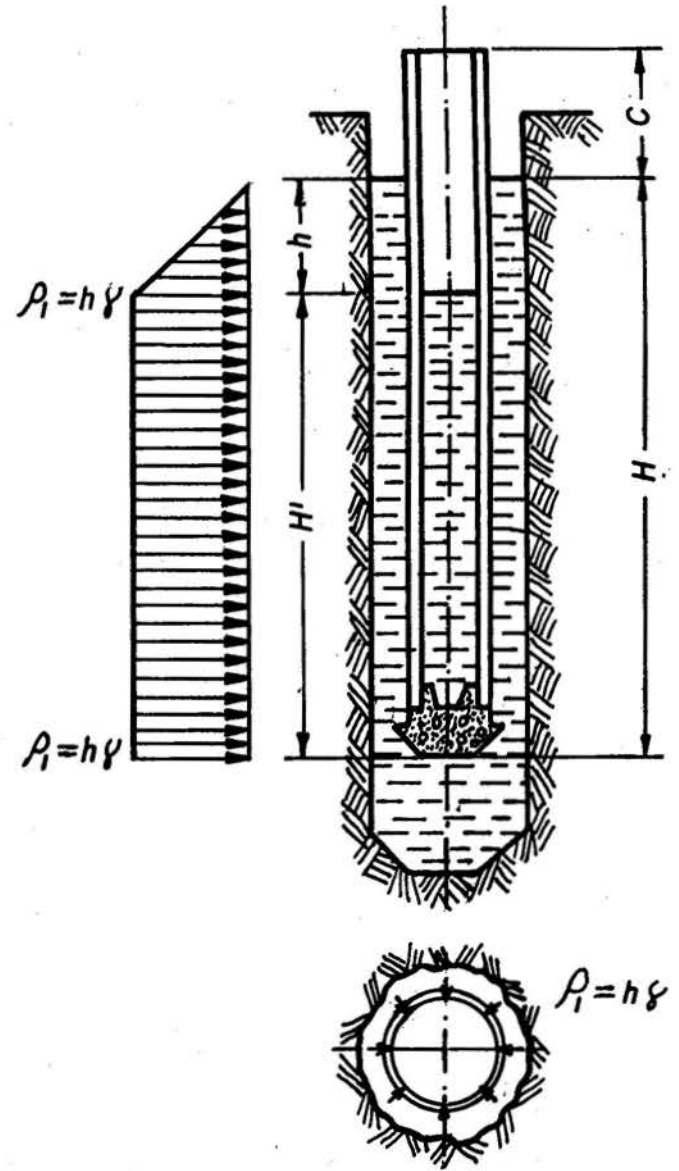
Esquema de cálculo de las fuerzas de montaje de la fortificación.
